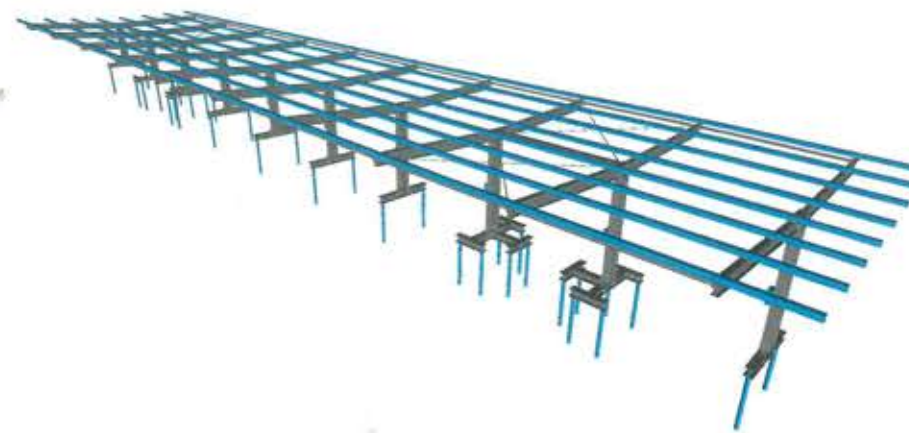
3D-Ansicht eines PV-Carports in BOCAD inkl. aller stahlbaurelevanten Details
